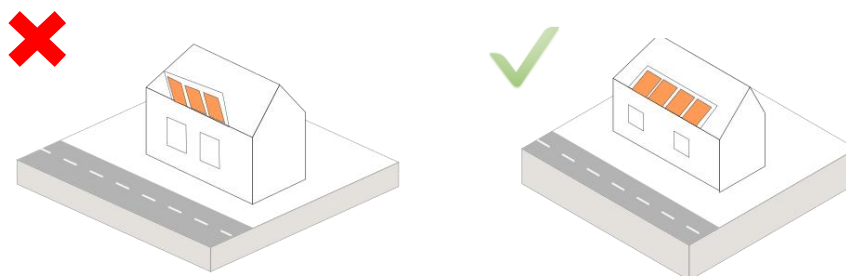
Les panneaux devront être implantés dans un plan parallèle à la toiture
